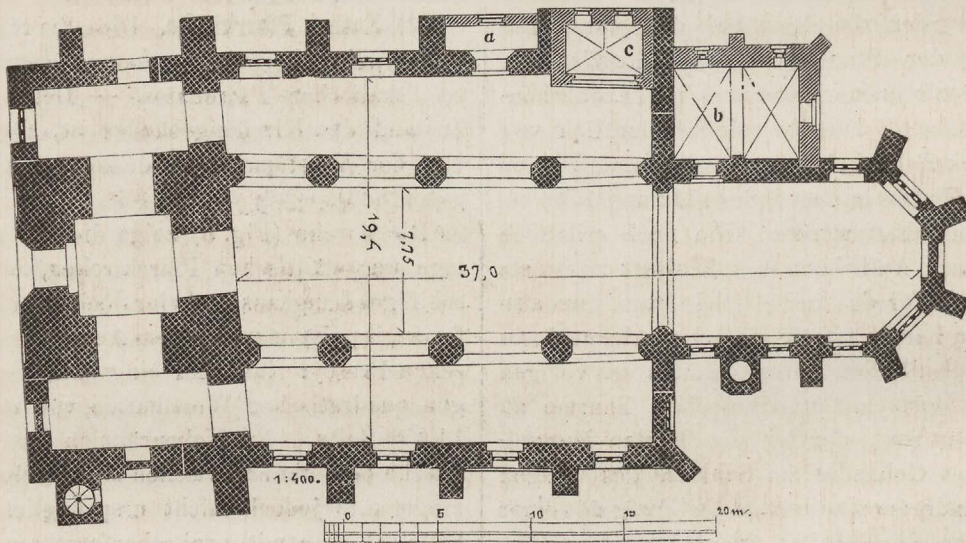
Konitz. Grundriss der kathol. Pfarrkirche.
